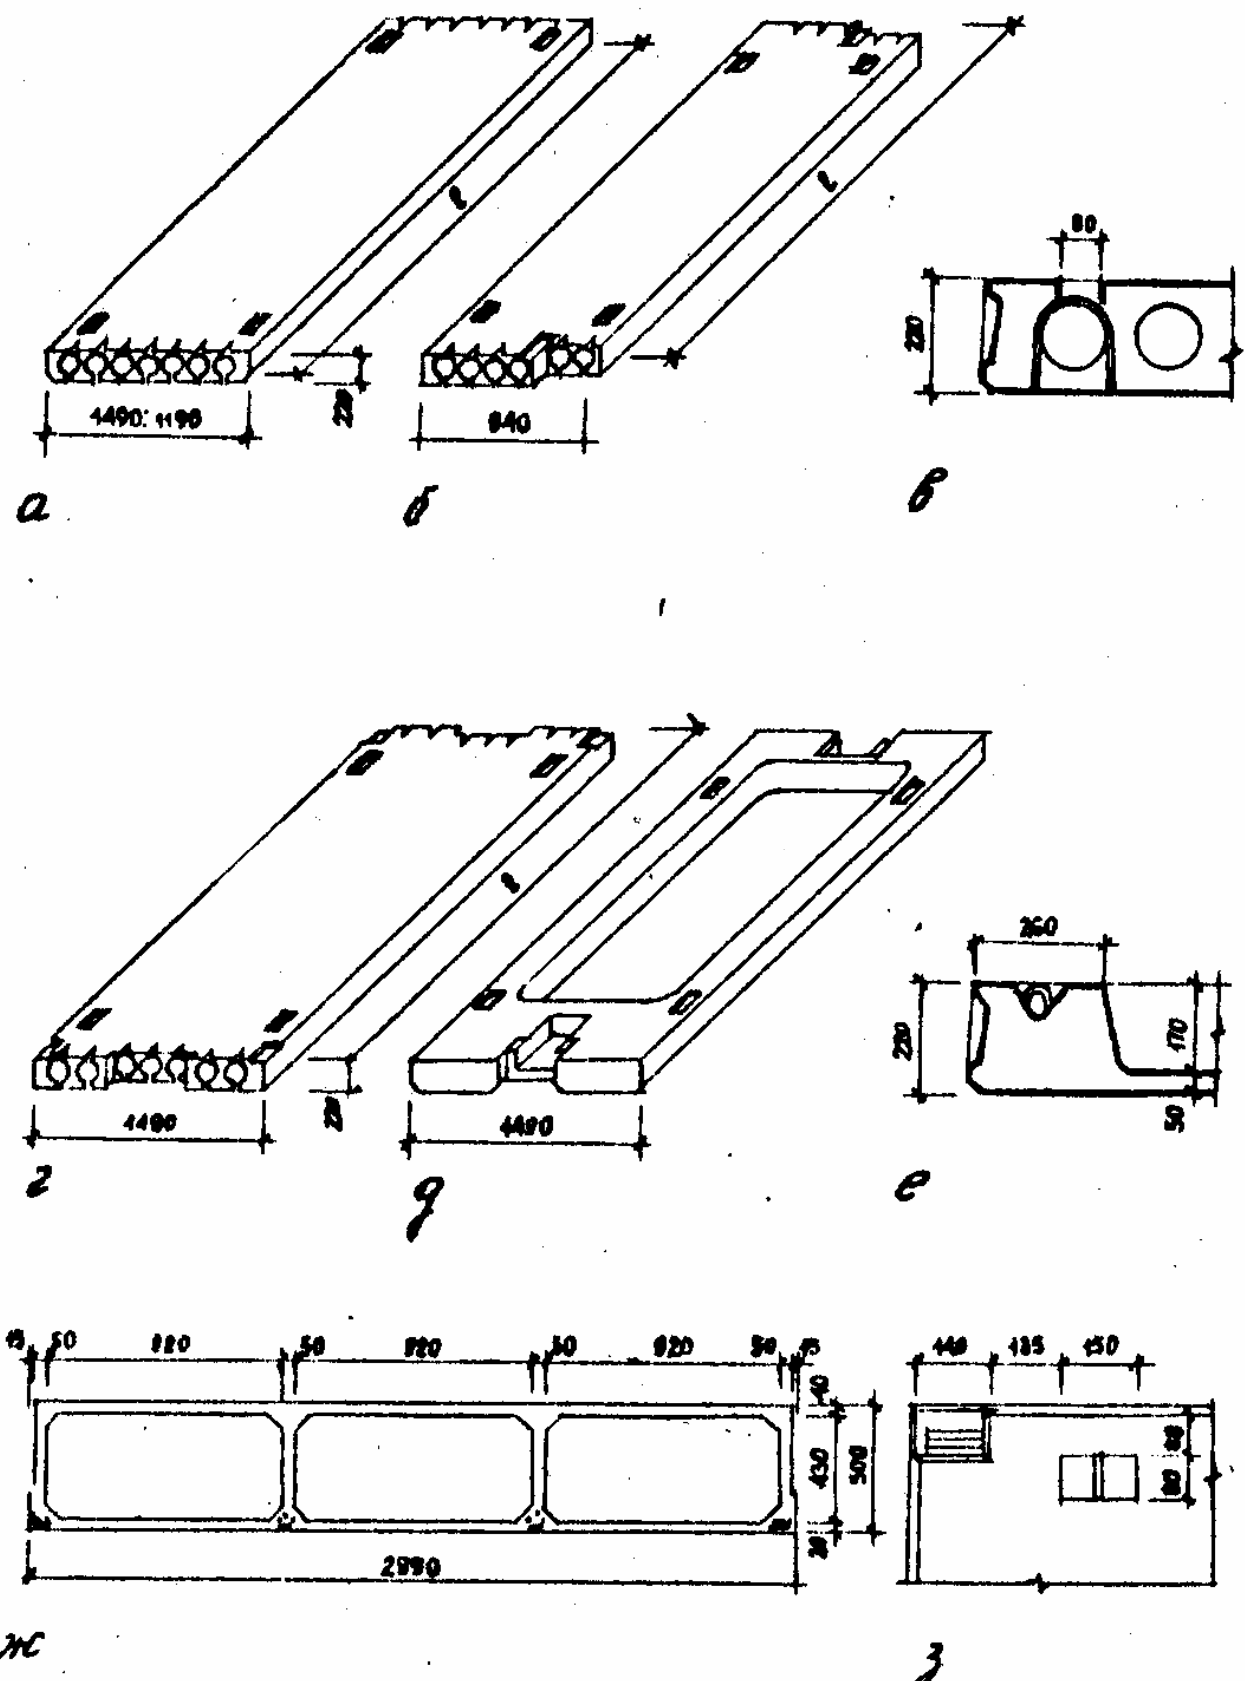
Схеми залізобетонних панелей перекриття каркасних будівель:
